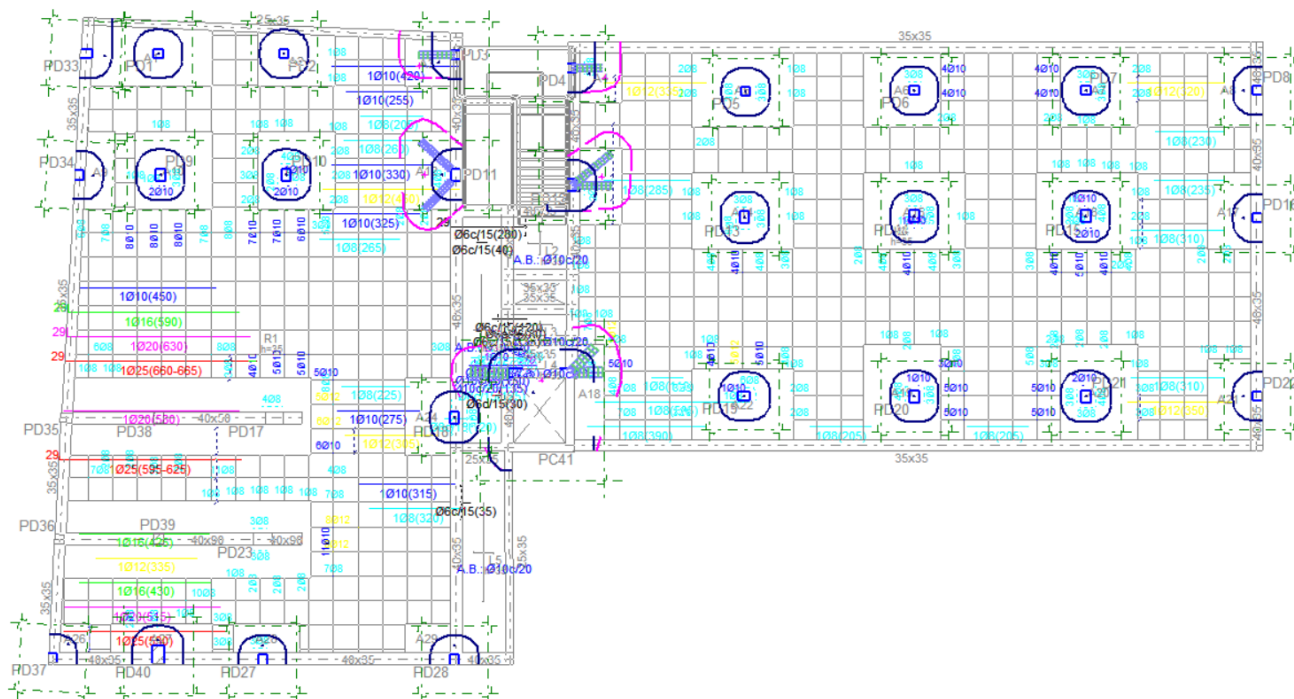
Punzonamiento Planta Segunda, Módulo D
